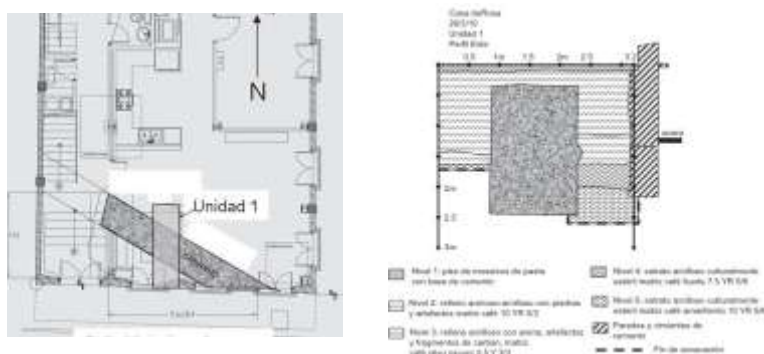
A la izquierda, planta de La Casa de Rosa, (escala 1:150) (Plano: Hache Uve, S.A.), a la derecha, perfil estratigráfico oriental del cimiento de mampostería (escala 1:40).
